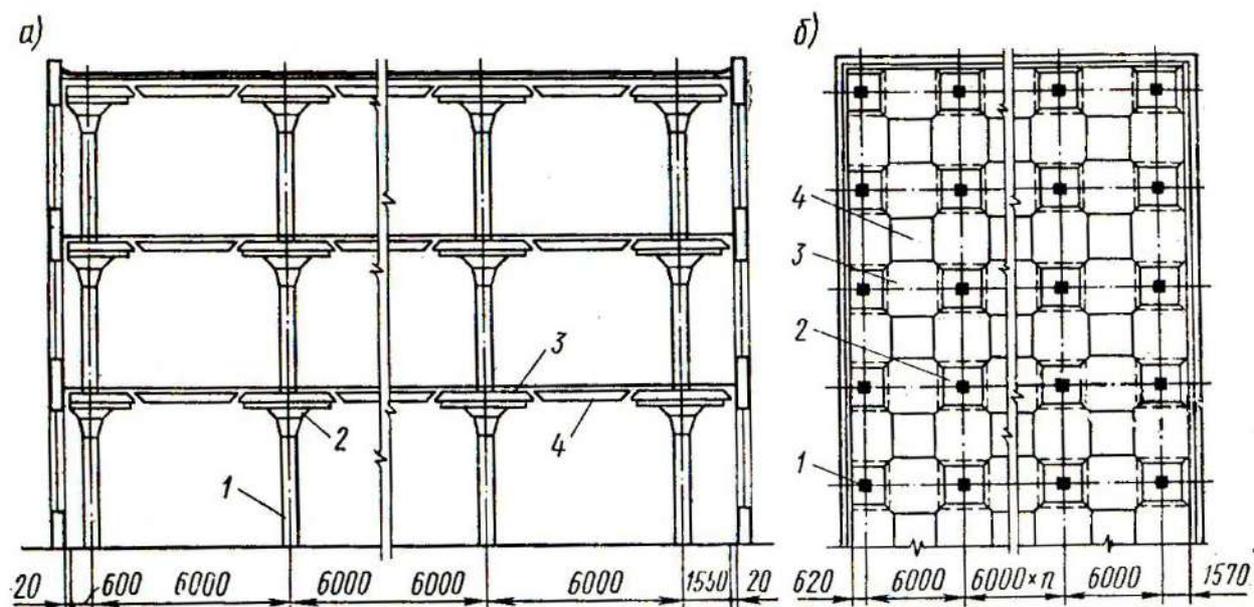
Многоэтажное здание с безбалочным каркасом:
